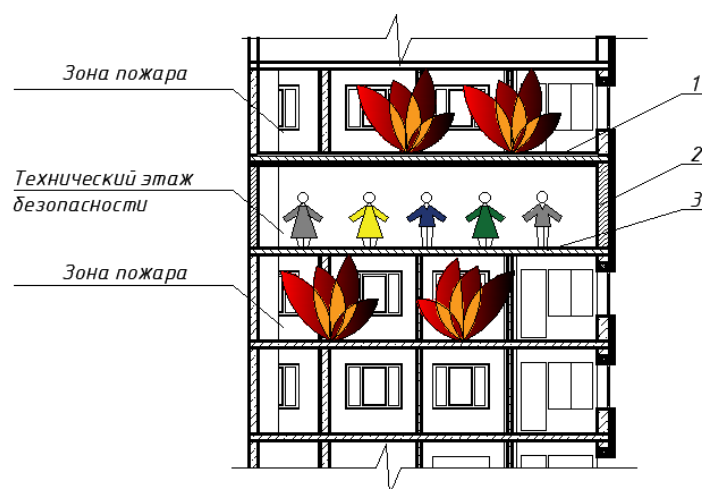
Схема технического этажа, обеспечивающего безопасность людей во время пожара: 1– верхнее огнестойкое перекрытие; 2 – огнестойкие стены технического этажа; 3 – нижнее огнестойкое перекрытие
